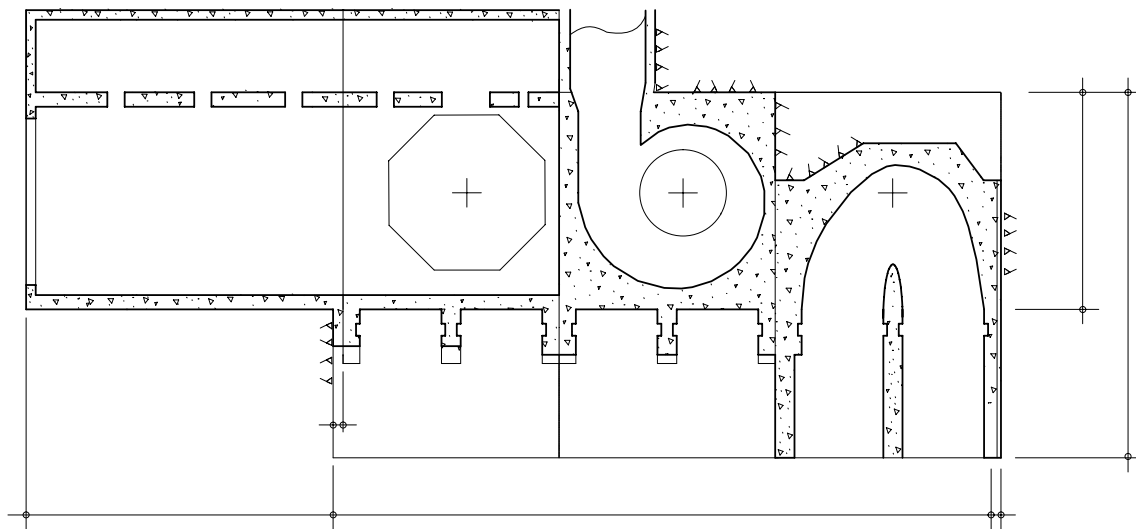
Planta da casa de força e área de montagem para turbinas Kaplan com caixa espiral de aço.
